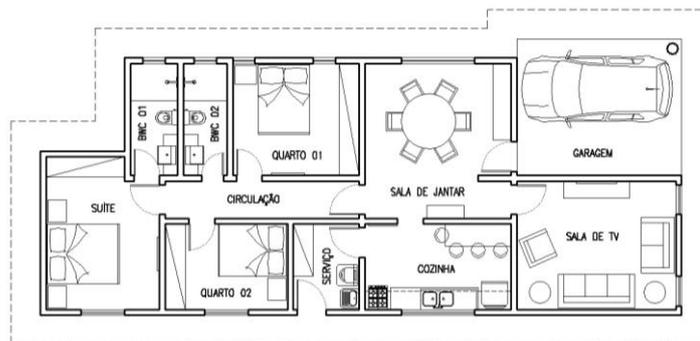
PLANTA BAIXA DA RESIDÊNCIA
